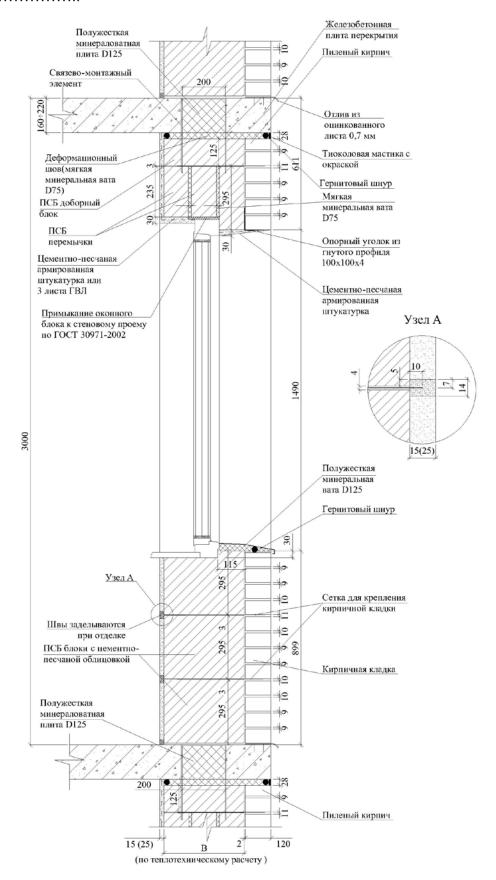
Ненесущая стена из ПСБ блоков с заводской цементно-песчаной облицовкой и наружной кирпичной облицовкой толщиной в 0,5 кирпича. Вертикальный разрез по оконному проему.
